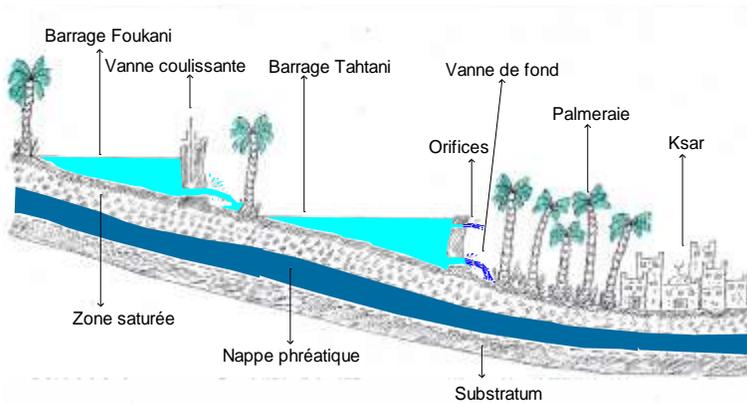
Croquis de la coupe longitudinale du système de barrages de l'oasis de Tiout (Remini, 2019)
